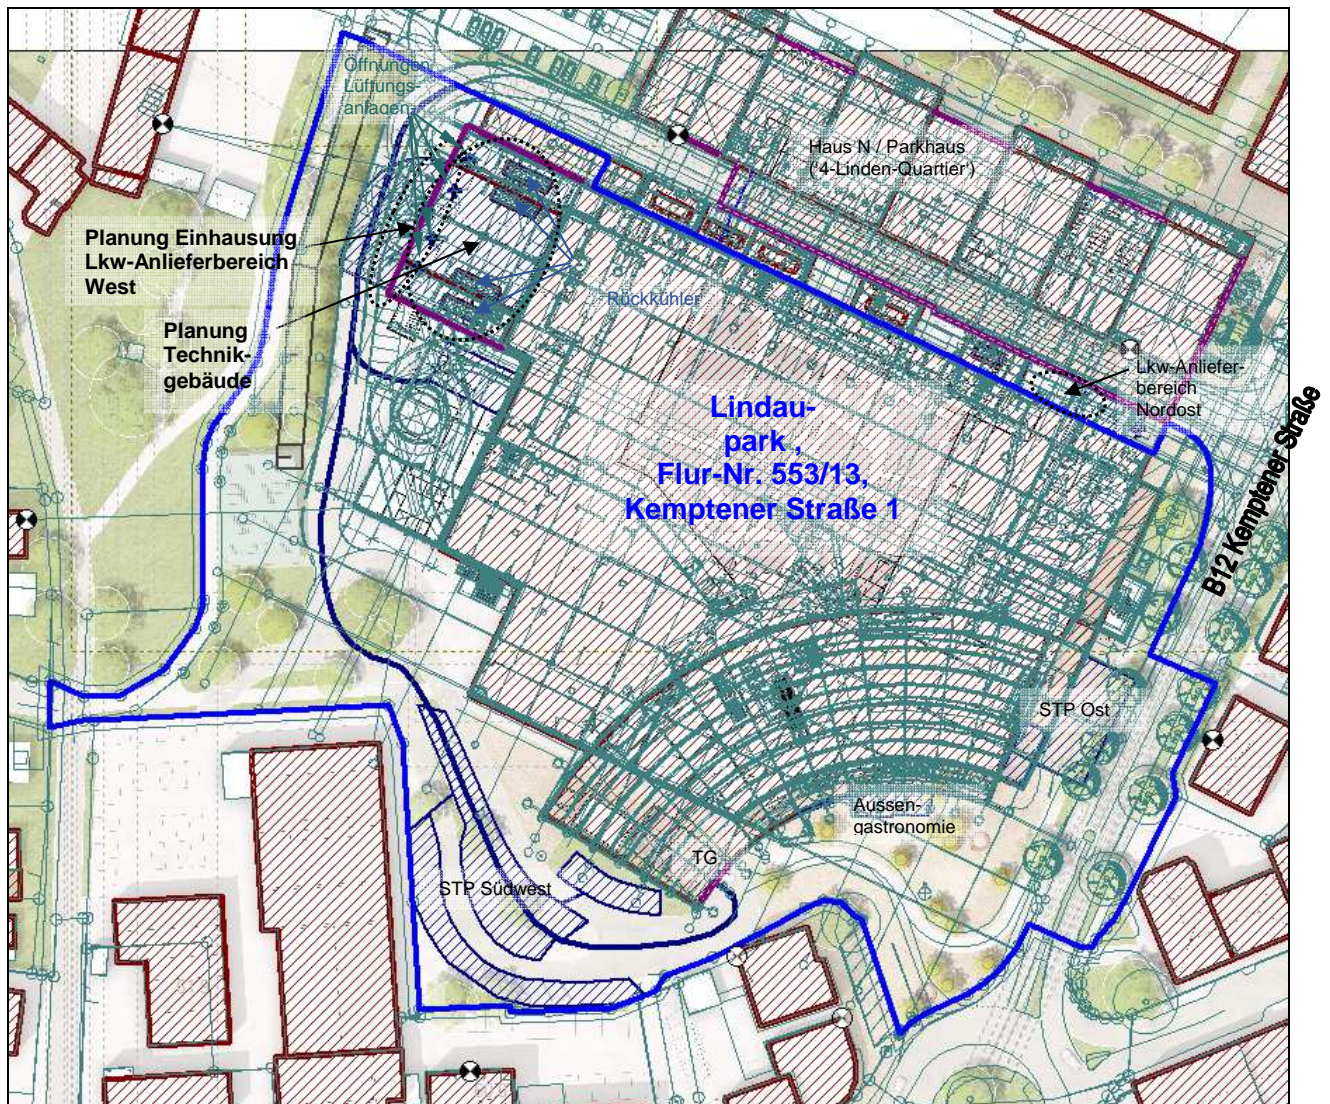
Lageplan Auszug schalltechnische Modellierung Planung Erweiterung Lindau-park, Schallquellen
